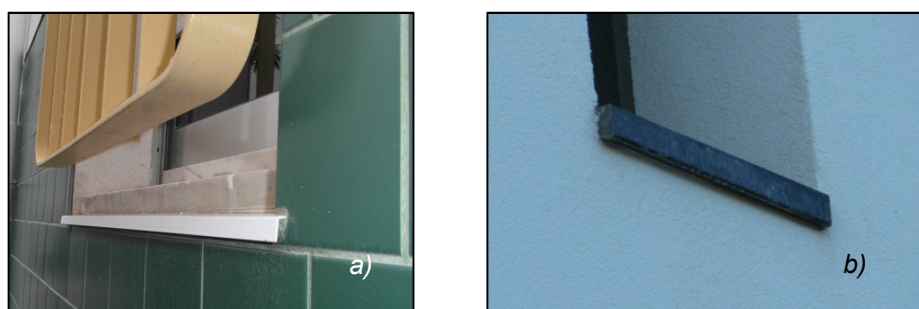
Protecção metálica em peitoris: a) Obra 25; b) Obra 20
